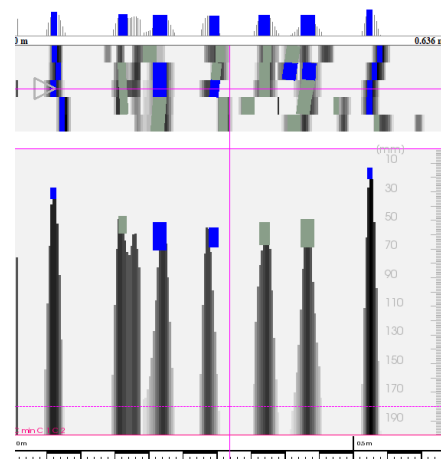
Poutre Pt04 – Travée 1 côté C0
